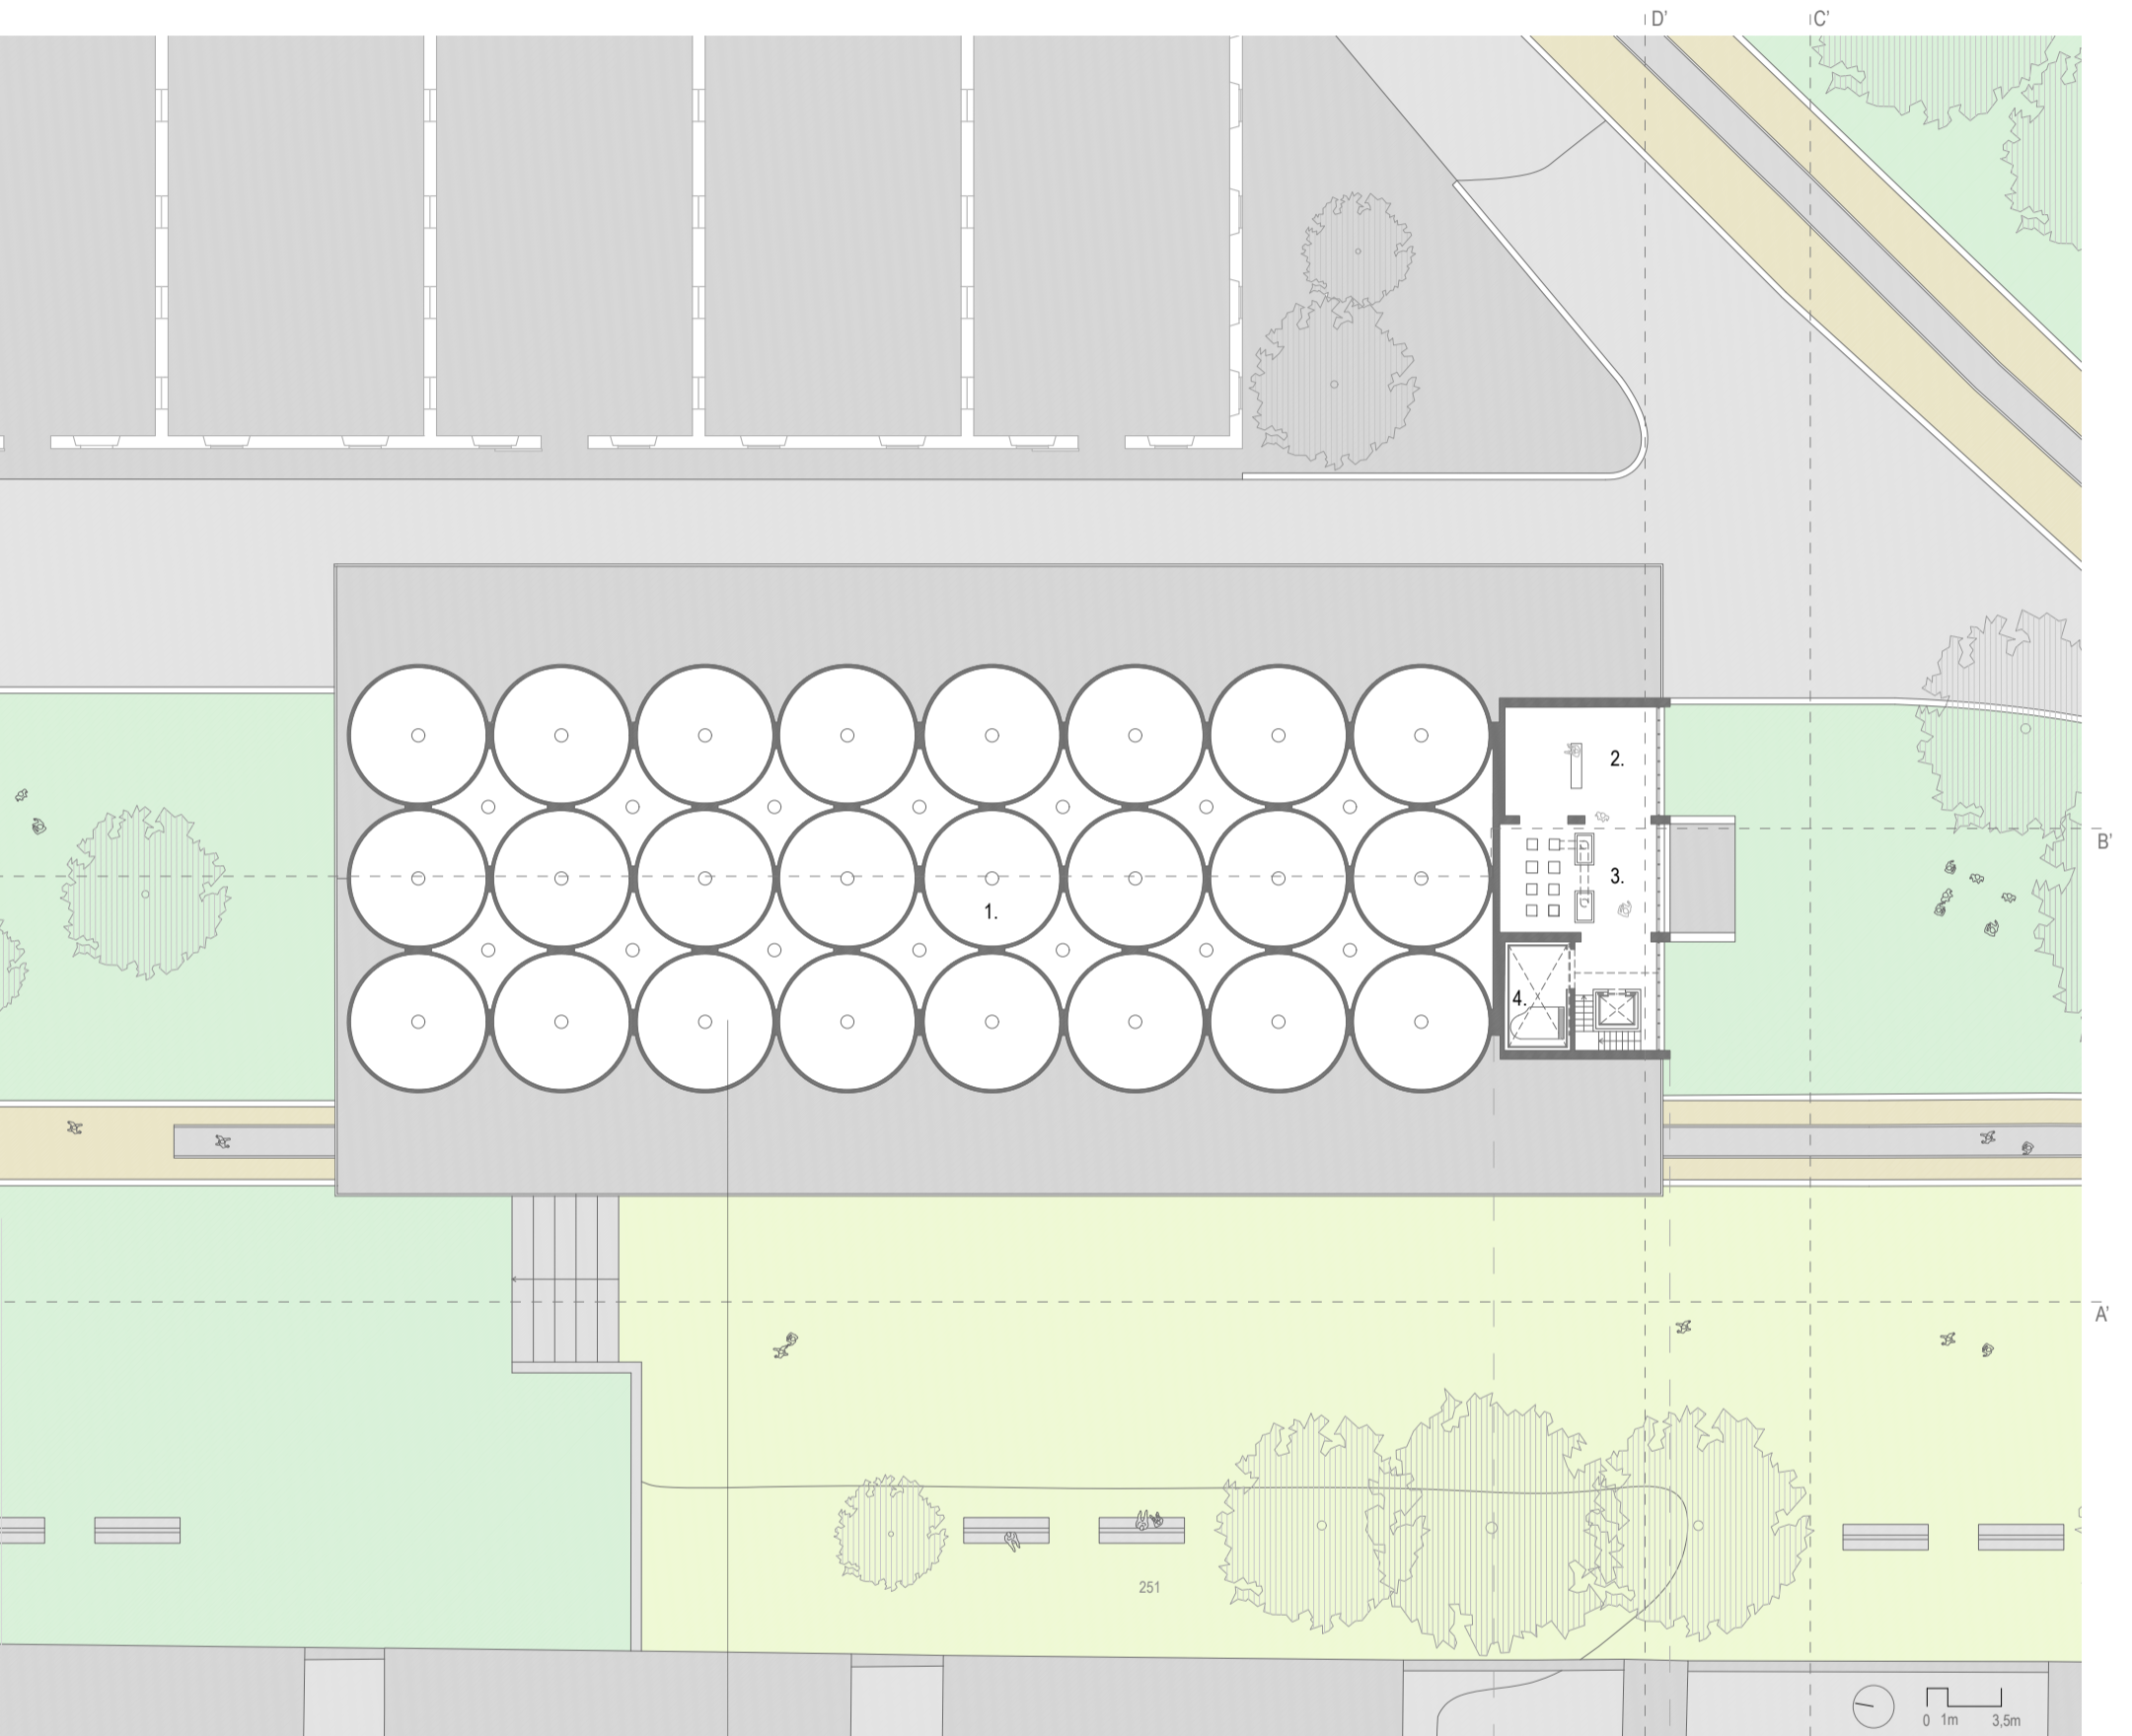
Planta piso 1. Proposta de intervenção, desenho do autor.
